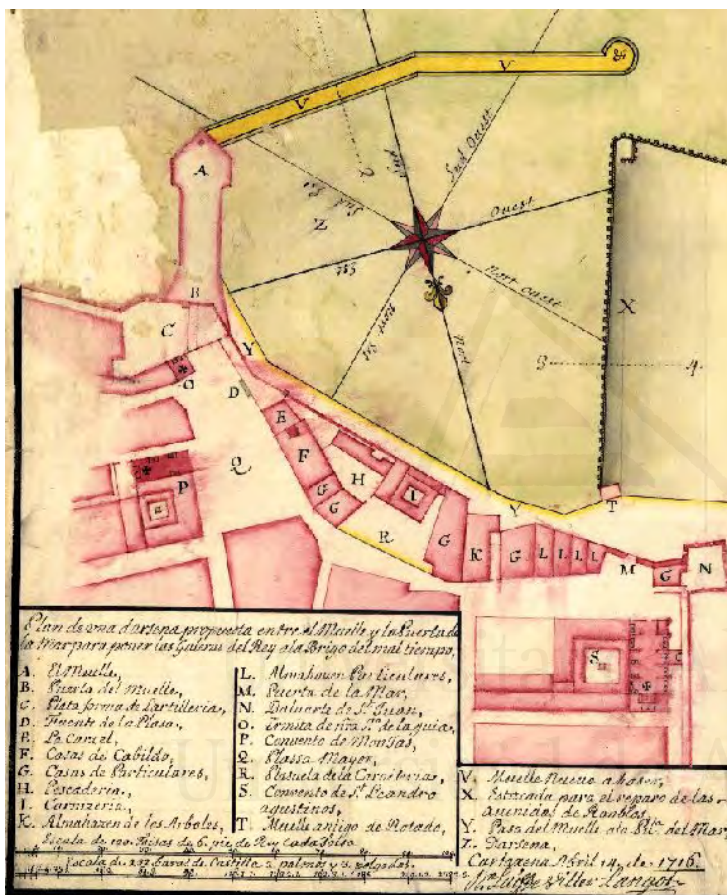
Detalle del plano del "Plan de una dársena propuesta entre el Muelle y la Puerta de la Mar para poner las Galeras del Rey al abrigo del mal tiempo" de 1716 (SGE MP RM, 40) donde se pueden apreciar marcado con las letras H: la plaza de la Pescadería y con la I: la Carnicería.
